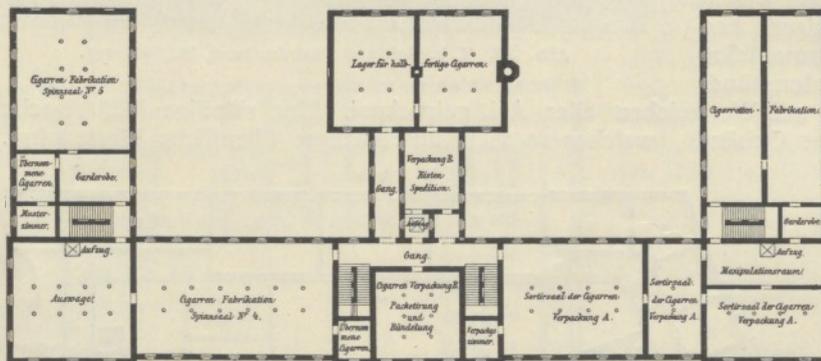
Fabrikationsgebäude. Grundriß des zweiten Stockes. 1:1000.
